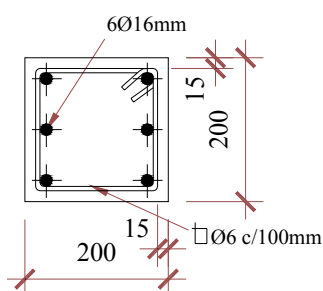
Detalhamento armadura do pilar na seção transversal.
